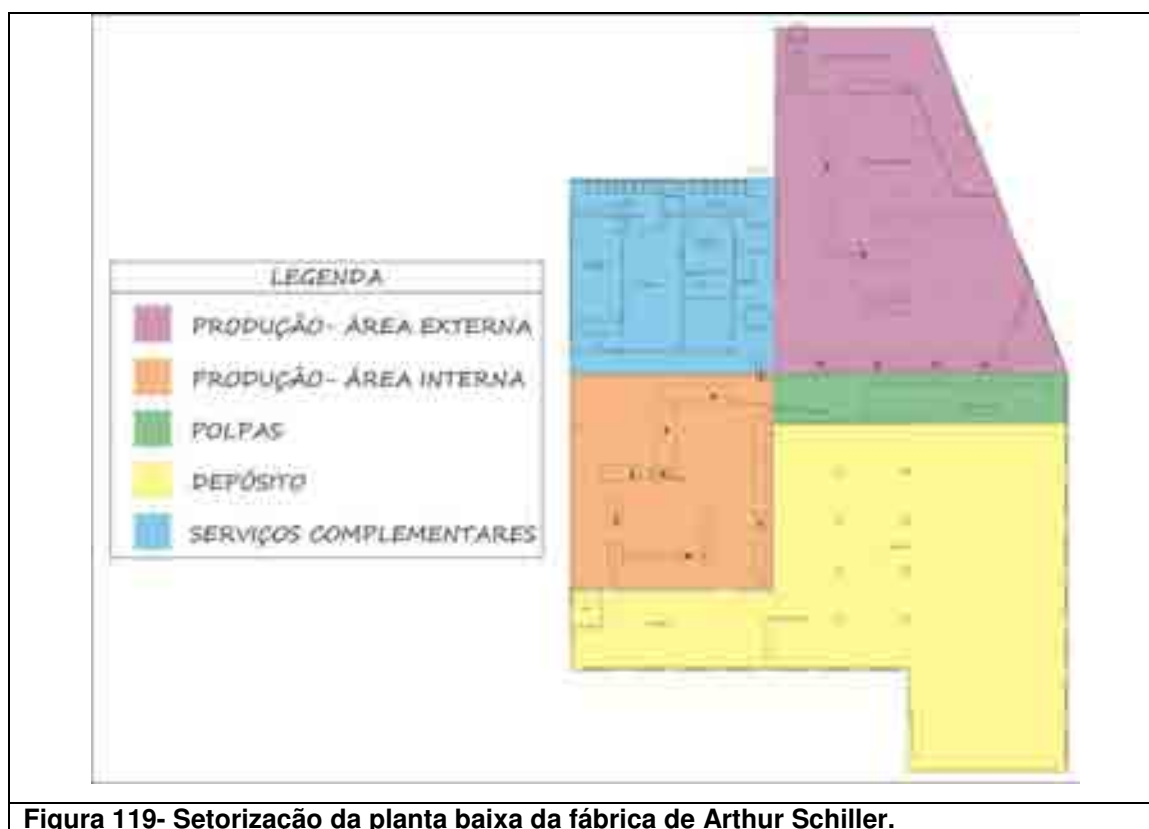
Setorização da planta baixa da fábrica de Arthur Schiller.
